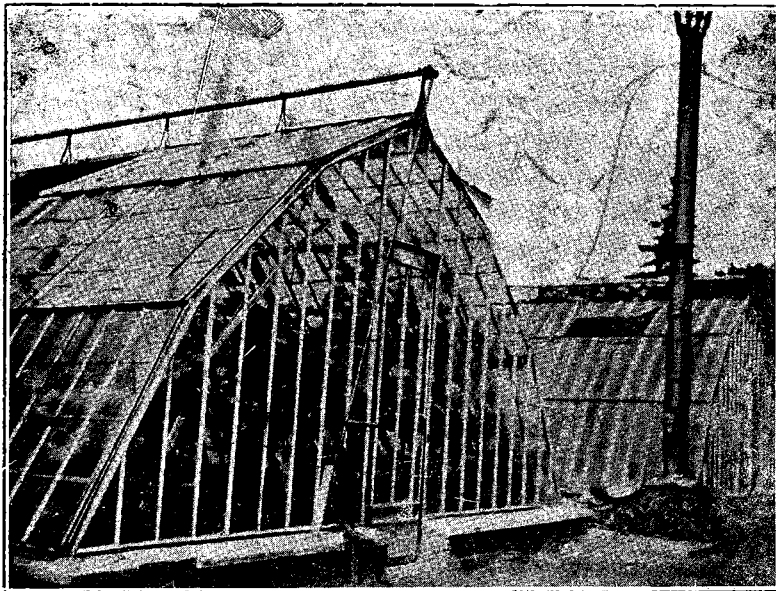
Seră cu două versante, construcție în beton armat și sticlă
